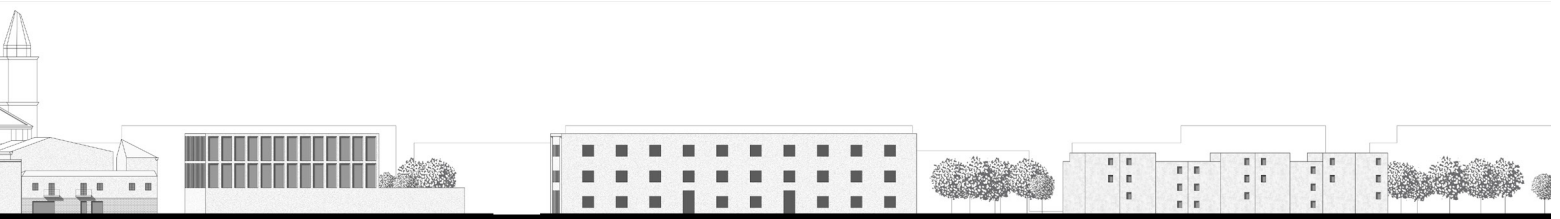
Planivolumetrico 1:1500, (pagine successive) pianta del piano terra e prospetti Nord e Sud
